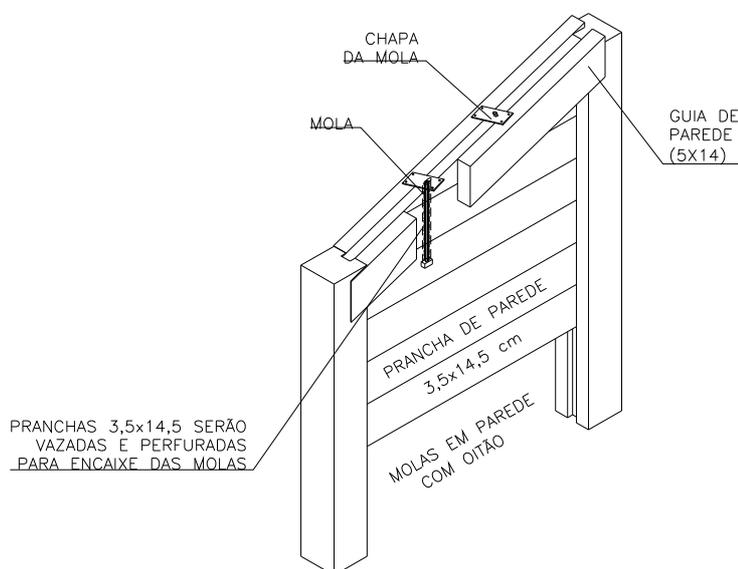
Precasa (2000) - Encaixe das molas nas “Guias de Parede”.
